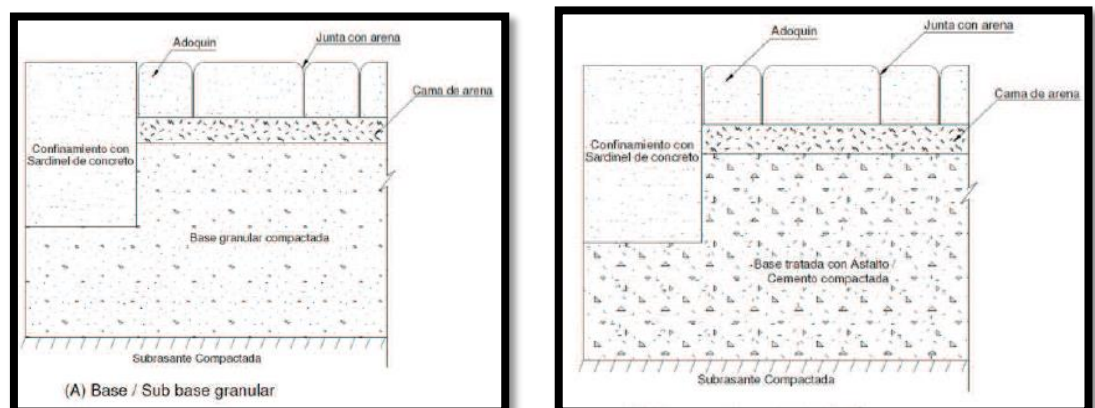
Secciones transversales típicas en pavimentos articulados
